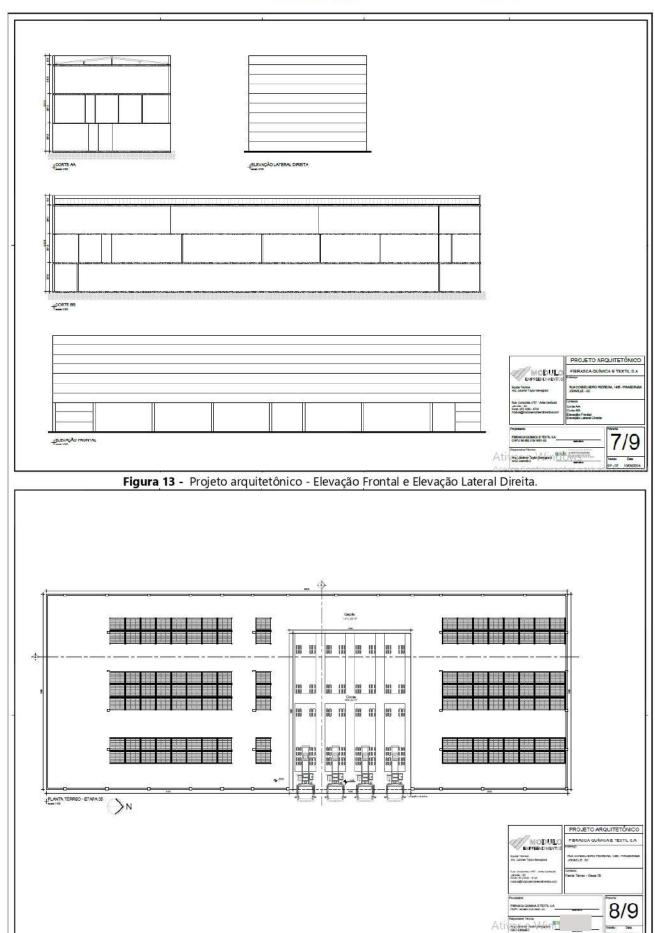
Projeto arquitetônico - Planta Térreo - Etapa 04.
